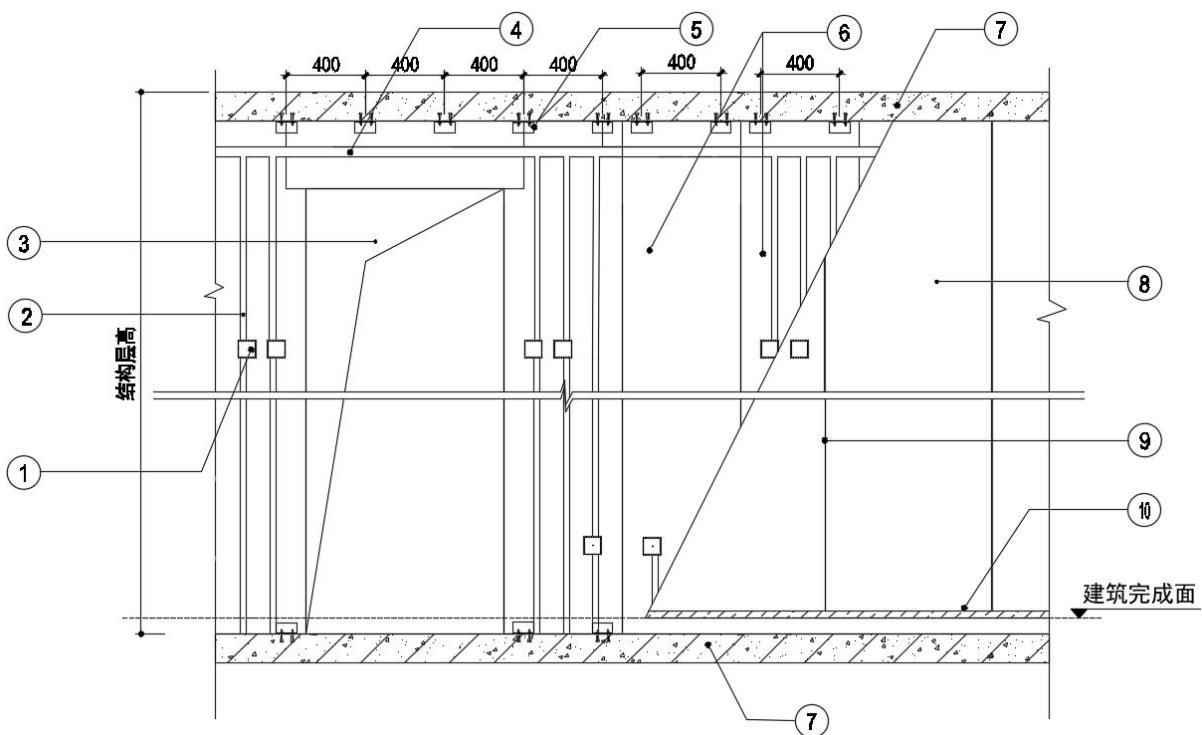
板材隔墙系统构造示意图（立面图）
